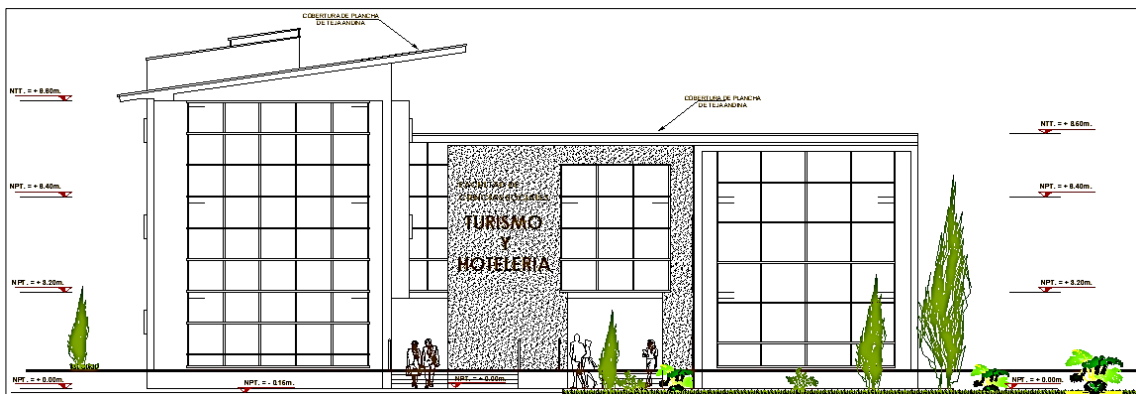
Vista lateral 1 del Pabellón de Turismo y Hotelería (Fuente: Planos de elevación)
